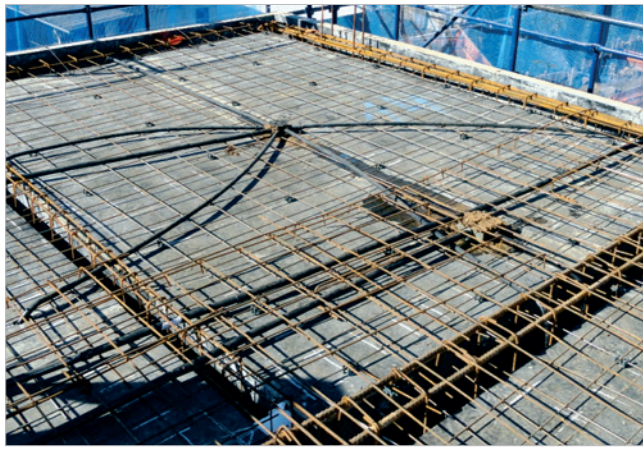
Medição do cobrimento da armadura positiva das lajes
